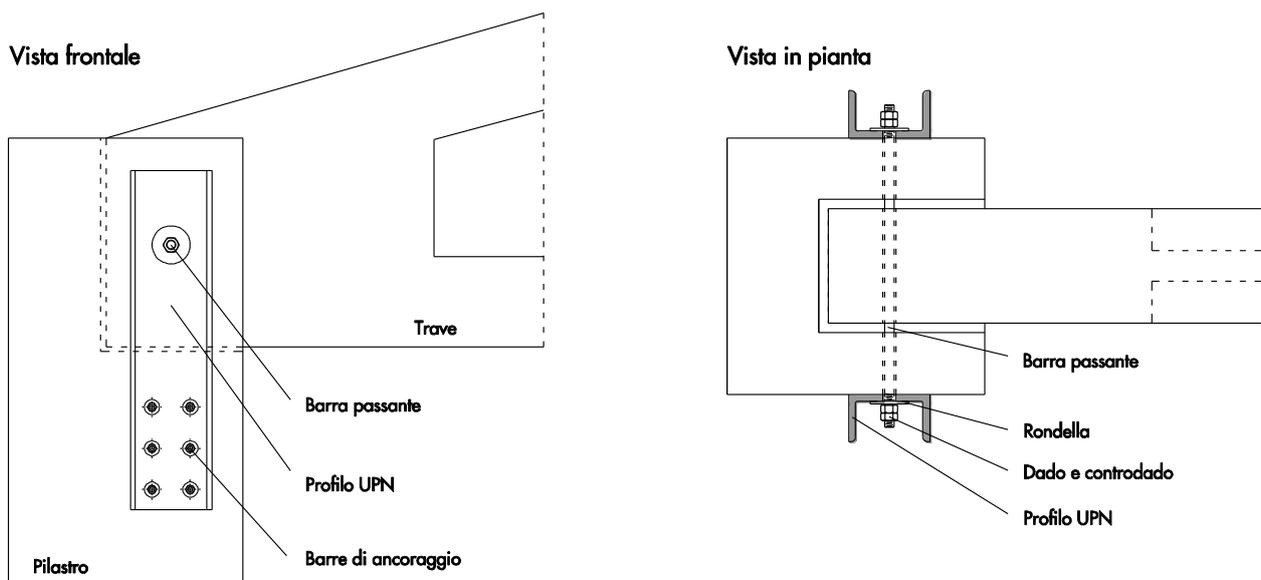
Collegamento trave-pilastro con vincolo a cerniera.
